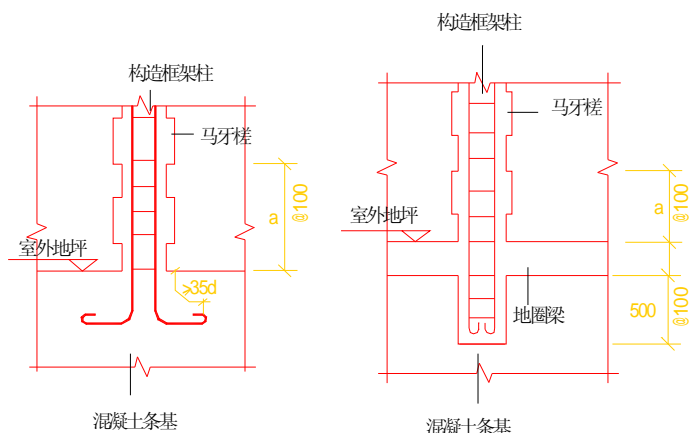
构造框架柱与混凝土条基连接示意图
